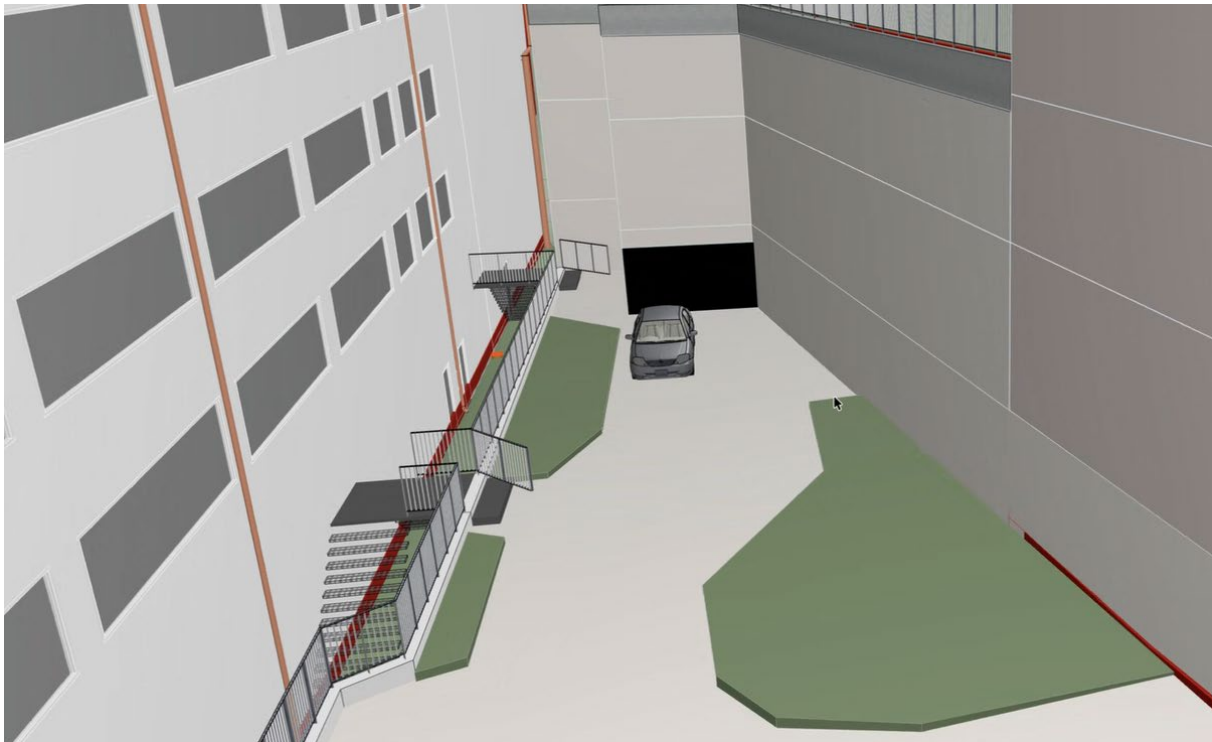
Bilden visar planområdet (markerad med röd heldragen linje) och byggrätter i gällande detaljplan utanför planområdet. Bebyggelsen är schematiskt illustrerad. Bild ÅWL/Nacka kommun, 2026.
